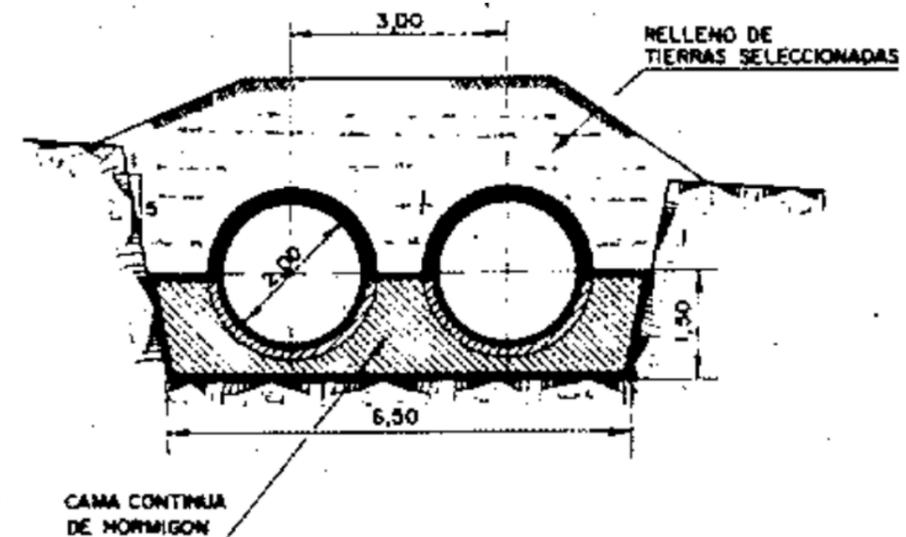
Sección del canal a la altura de la zona del Anteproyecto
